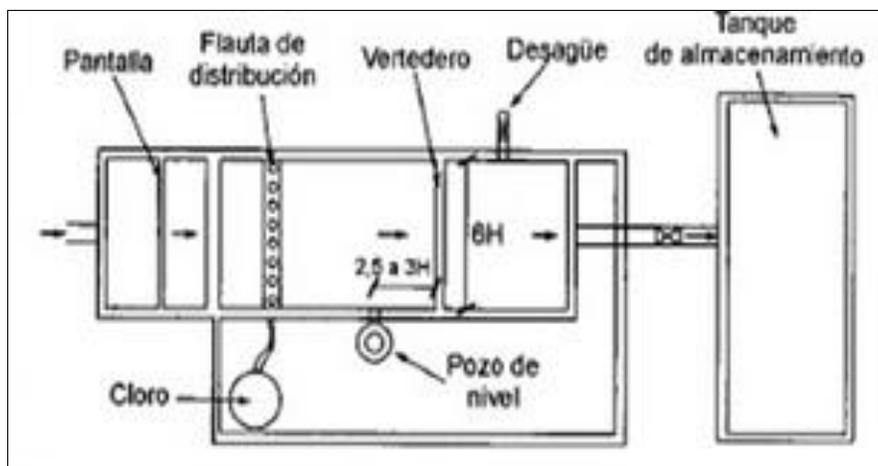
Caseta de cloración (vista planta o desde arriba)²⁴
